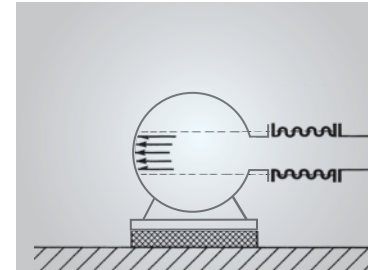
Axiale Druckkraft auf ein Aggregat horizontal wirkend
